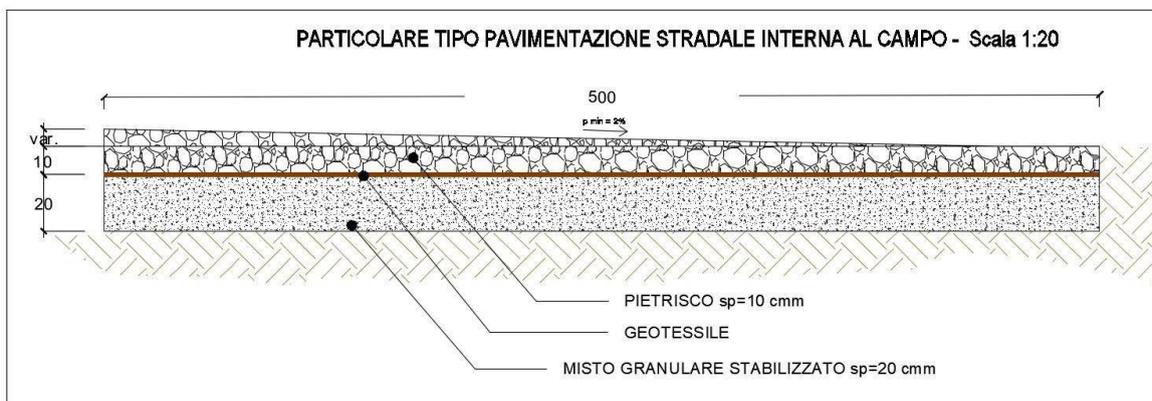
Particolare pavimentazione stradale interna al campo.
